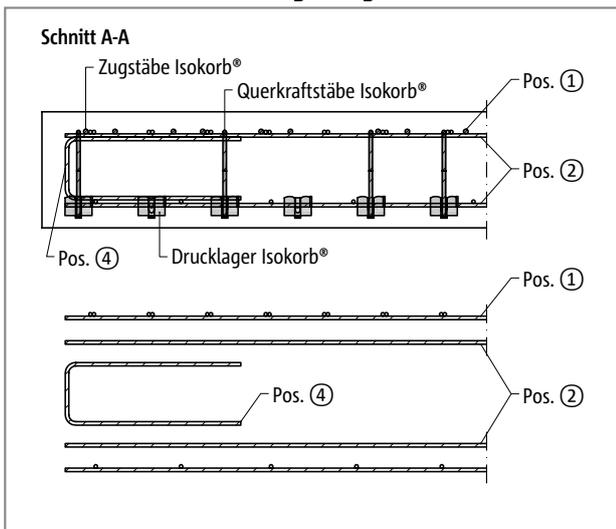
Schöck Isokorb® Typ KXT: Bauseitige Bewehrung balkonseitig im Schnitt A-A; Pos. 4 = konstruktive Randeinfassung am freien Rand
